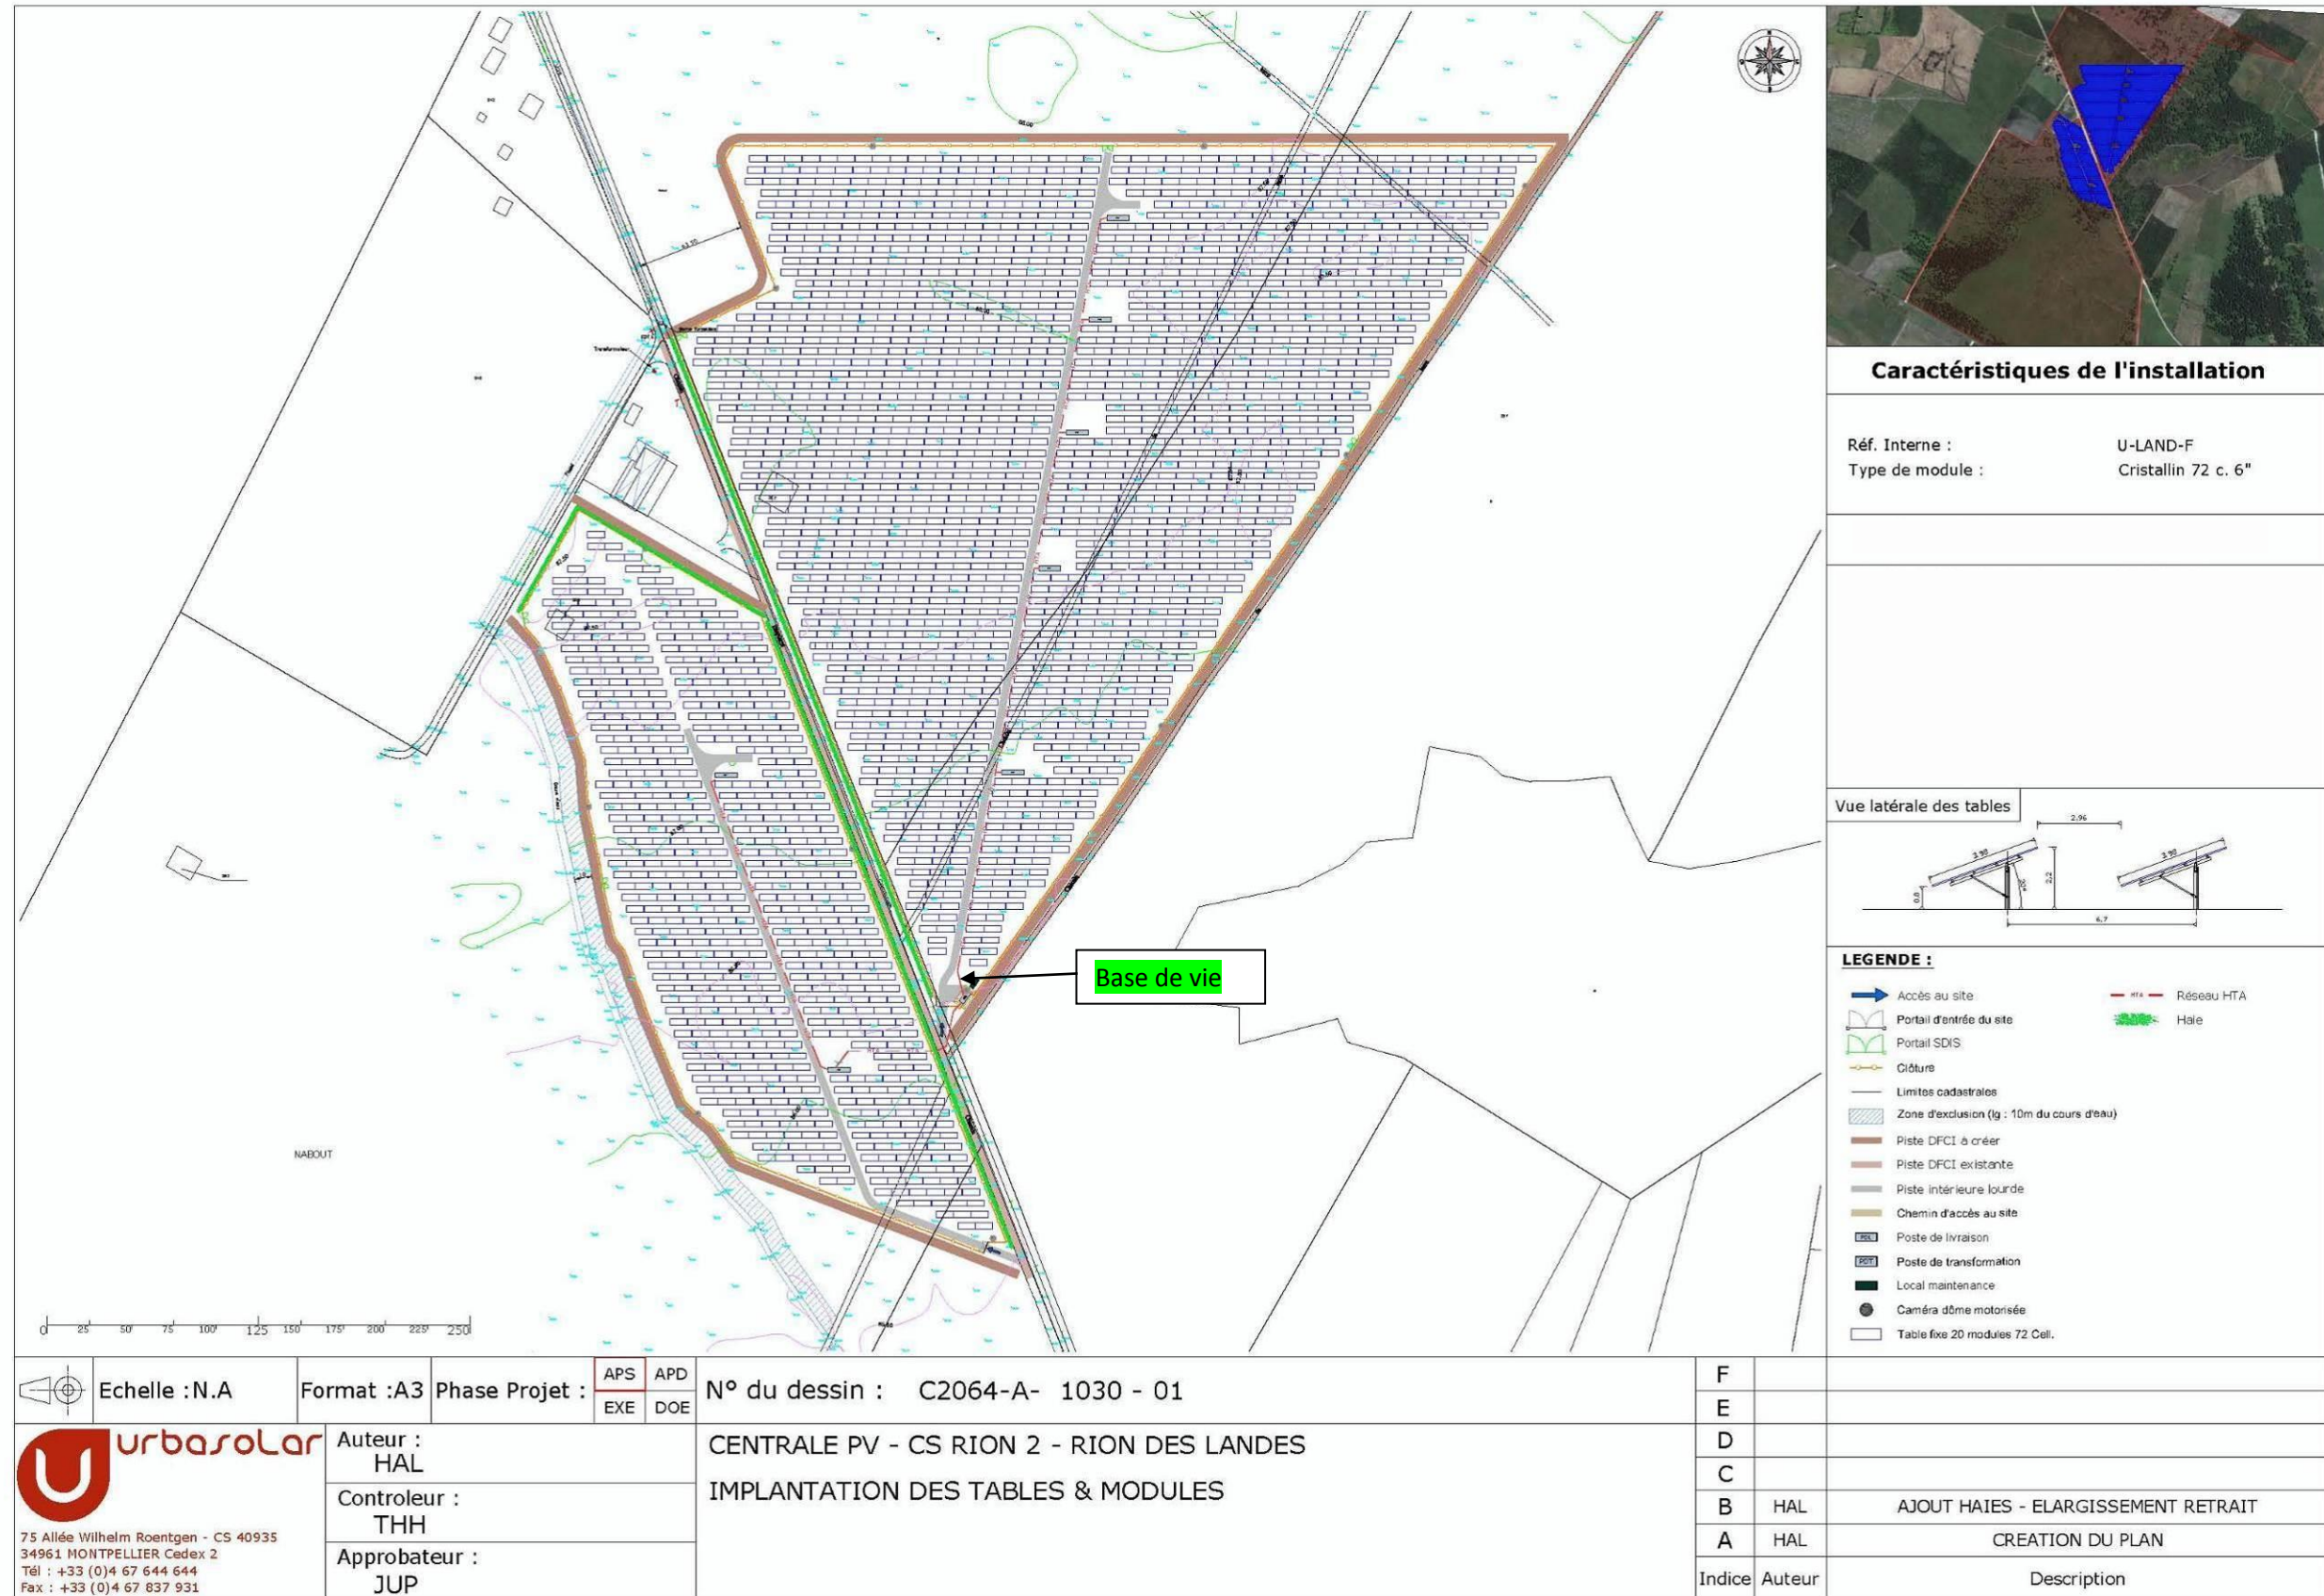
Plan de masse des projets (Tranche 2 – URBA 136)
